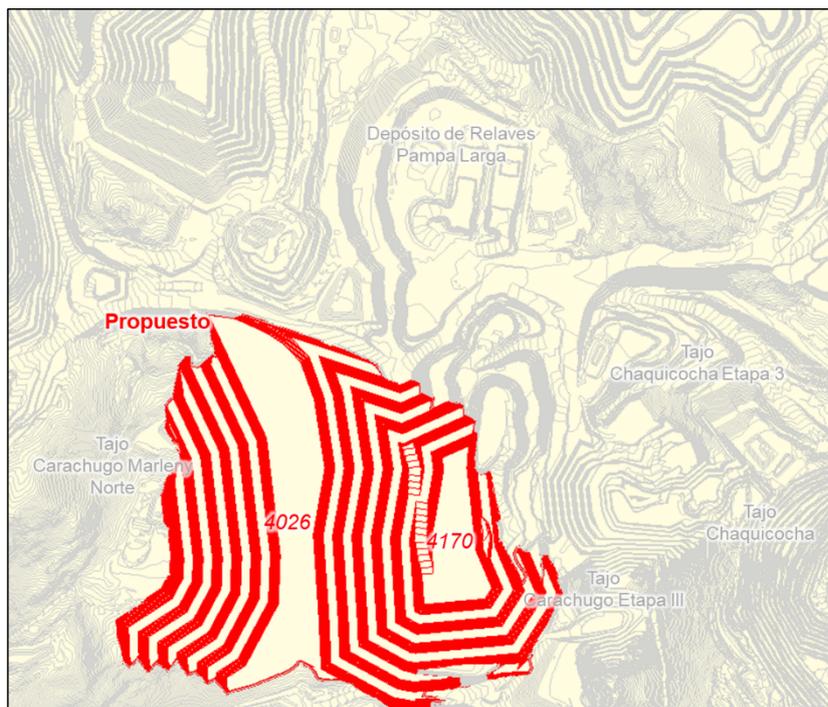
Plan de descarga del Relleno Carachugo Etapa 3 – Año 2021 – Vista en planta
